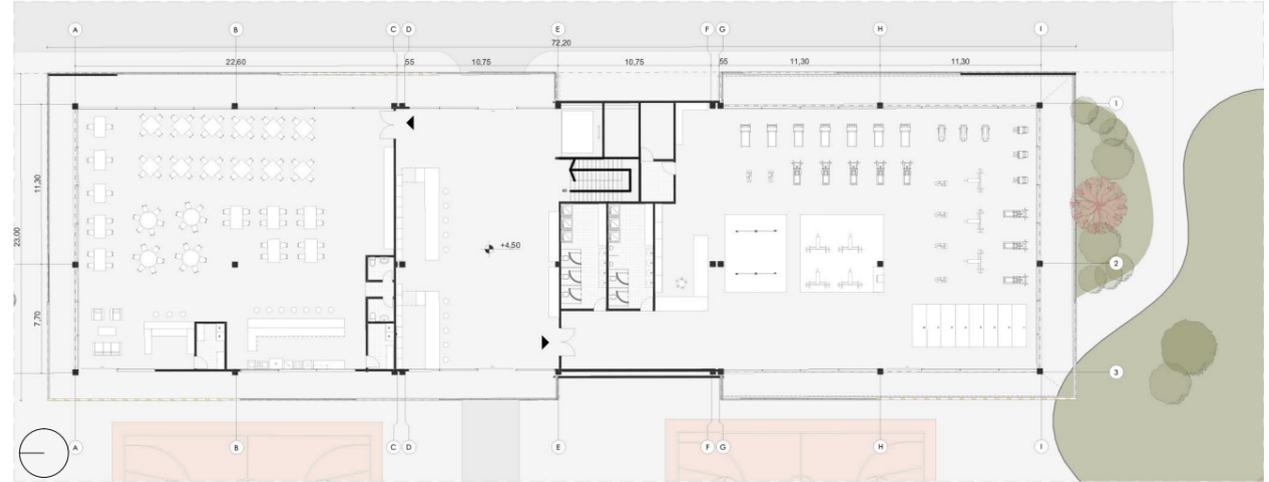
Planta para referencia bloque central Fuente: Propia, 2022
